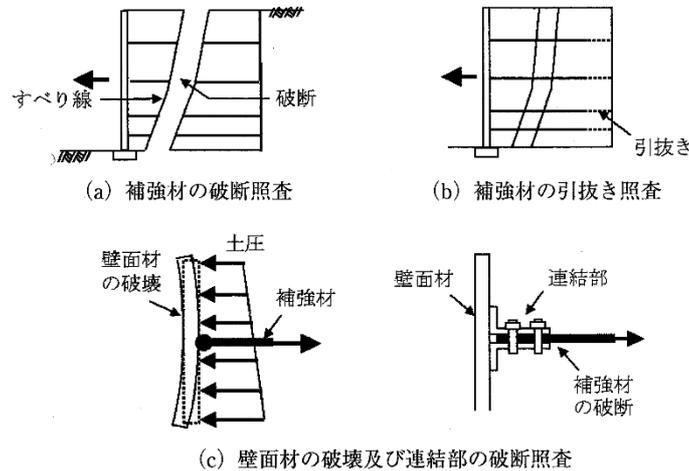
部材の安全性の照査における照査項目⁸⁾
